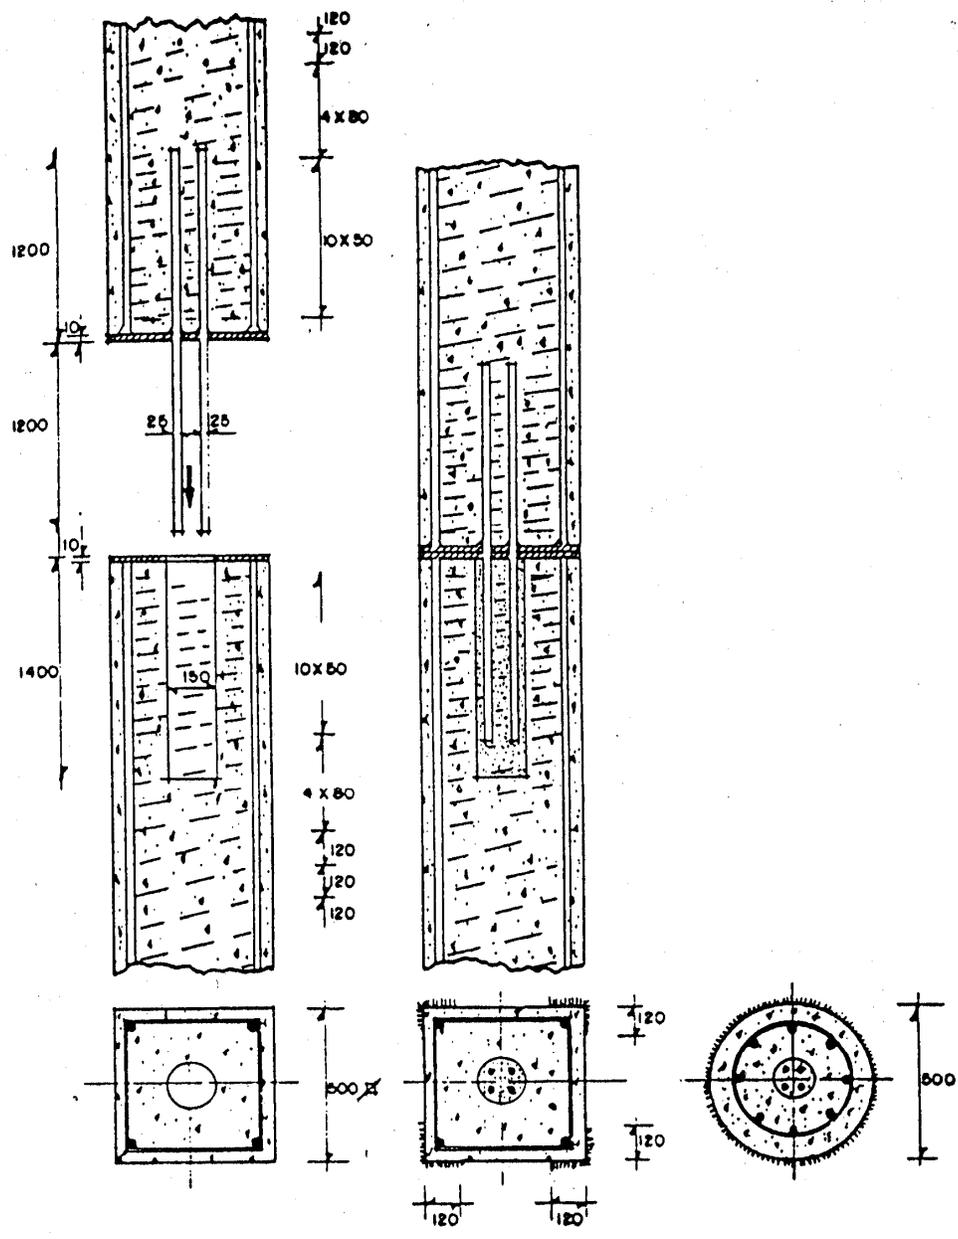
ACOPLAMIENTO POR SOLDADURA SISTEMA AVELAR
